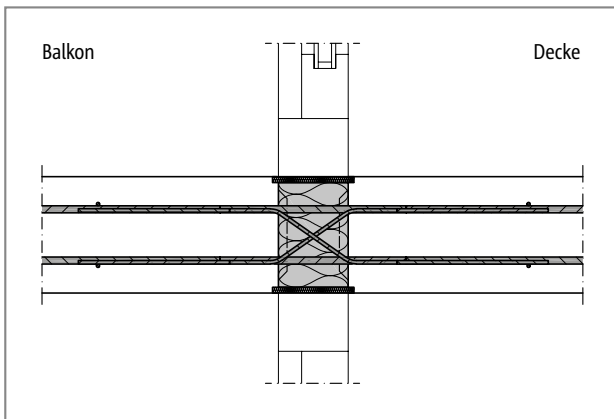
Schöck Isokorb® XT Typ D: Einbauschritt; einachsig gespannte Decke
